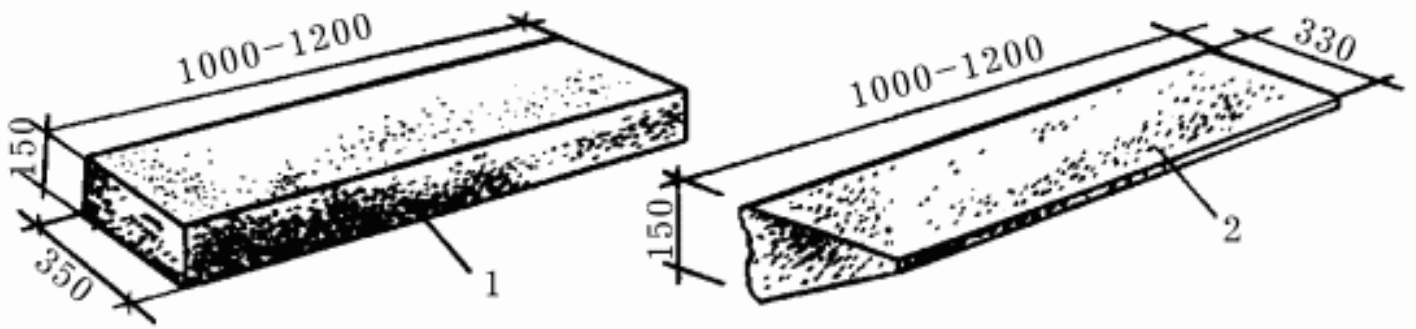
Готовые бетонные блоки: 1 – прямоугольный бетонный блок; 2 – готовый блок под косоур.
